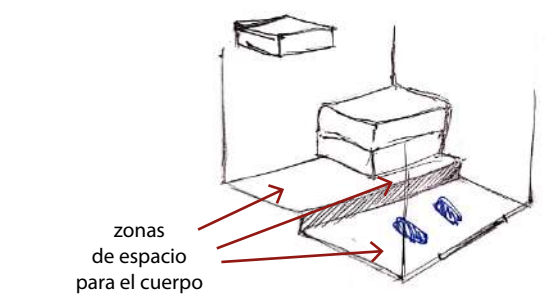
Croquis, Proyección baño 2. Elaboración Personal
